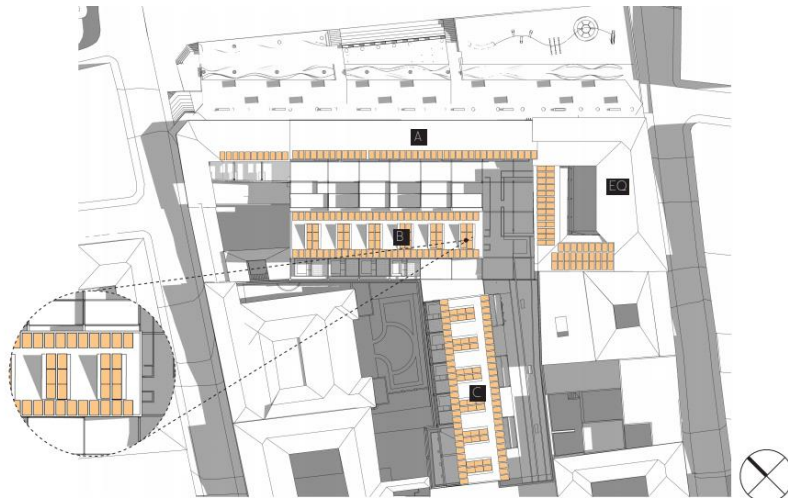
Distribución de paneles solares en las cubiertas. Elaborado por Nacevilla 2020
